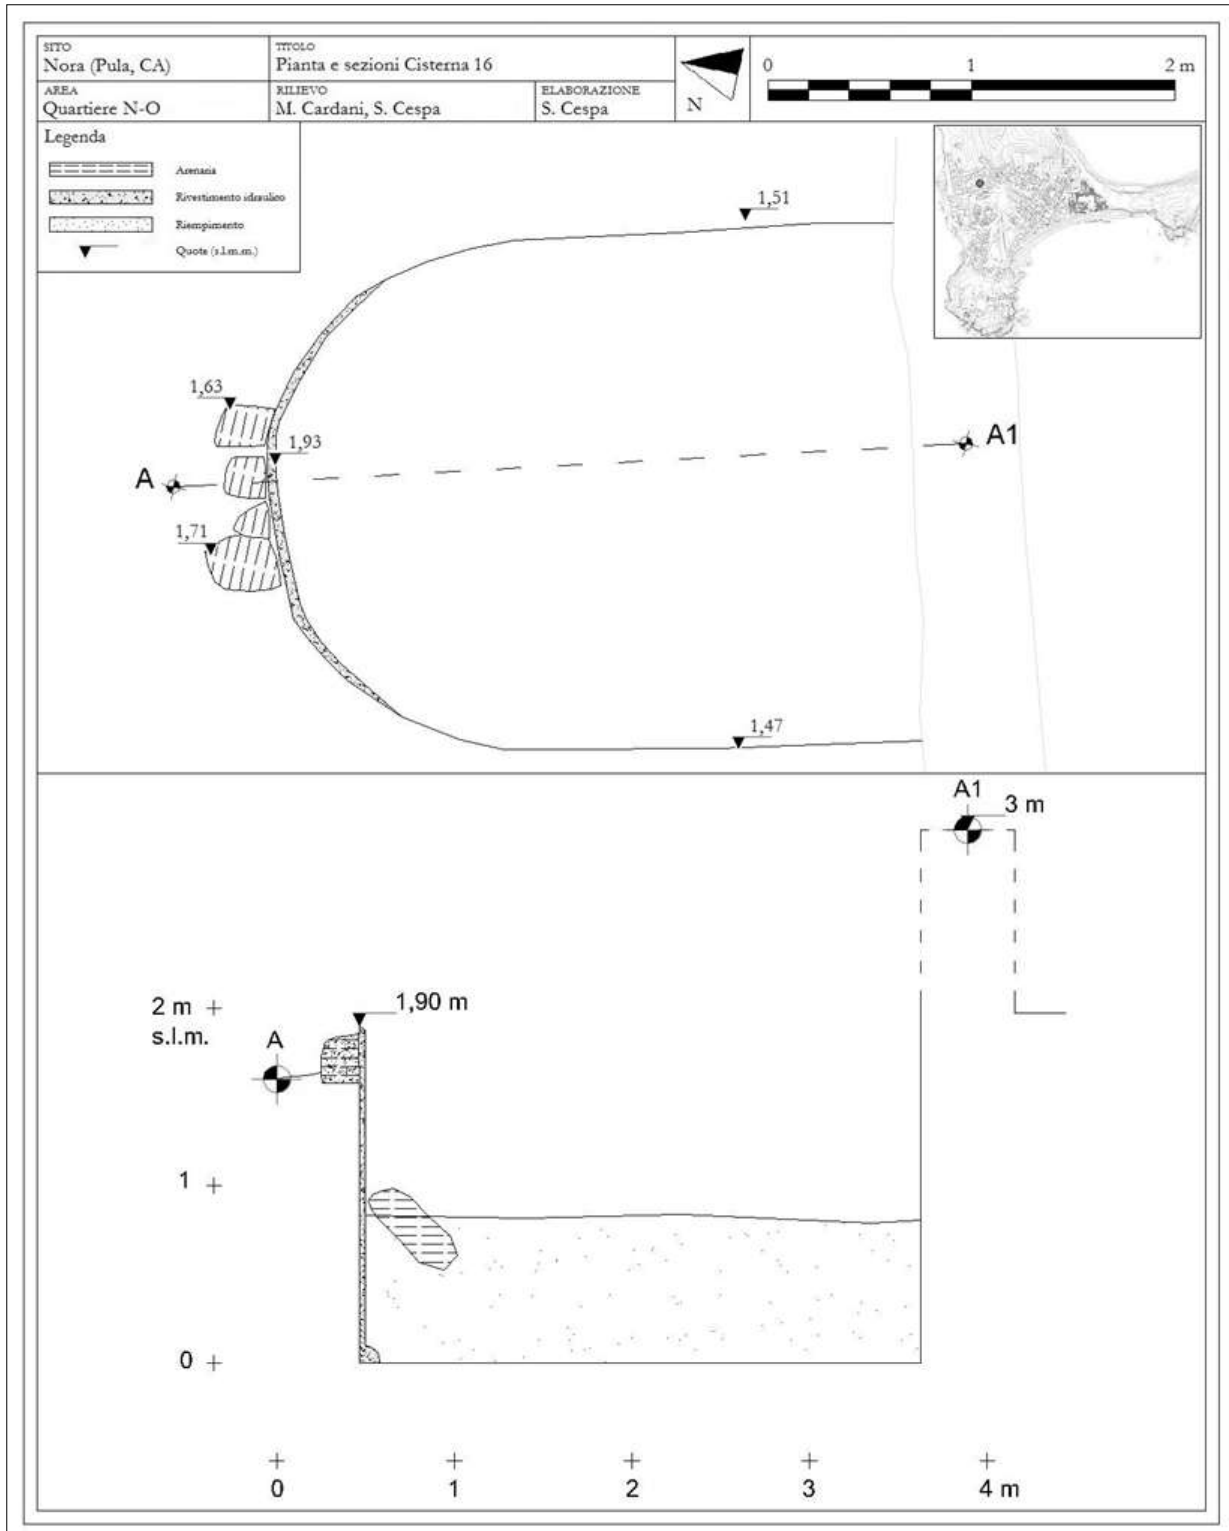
Pianta e sezione della cisterna 16 (elaborazione dell'autore).
